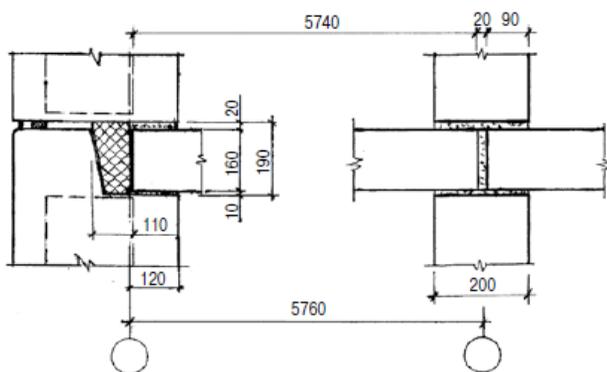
Пример измененной схемы опирания плит перекрытий на продольные стены
